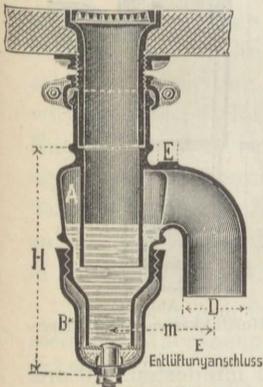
Geruchverschluß mit abschraubbarer Schlammschale.
